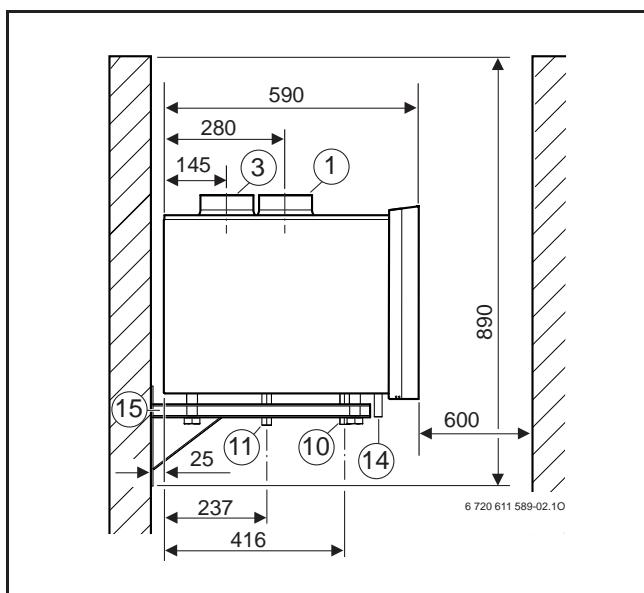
Bau- und Anschlussmaße (Maße in mm)
